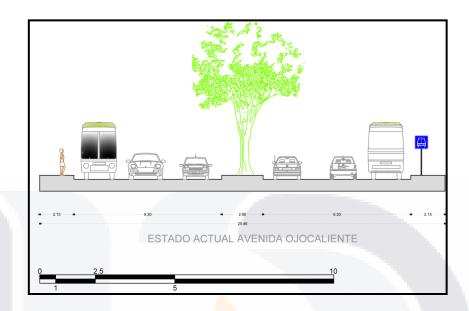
Sección transversal del estado actual de la avenida Ojocaliente
